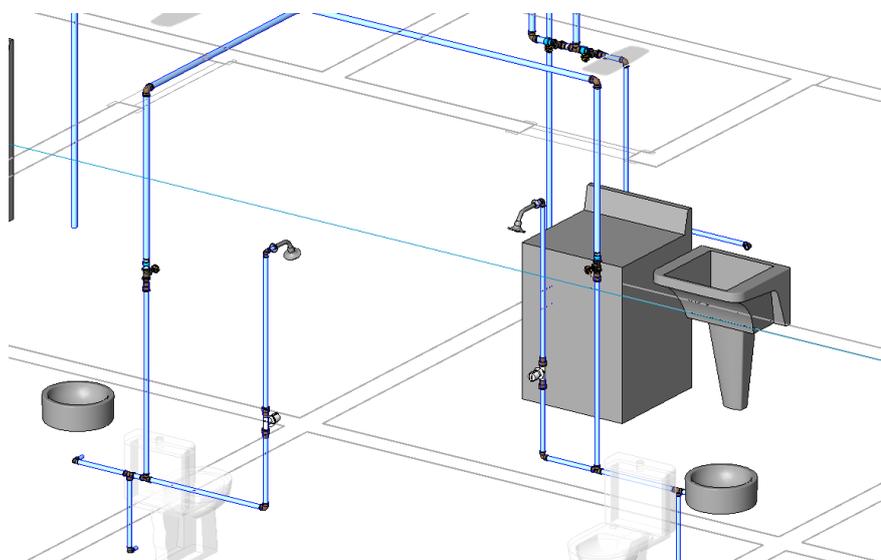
Traçado do sistema de água fria da lavanderia e banheiro do pavimento tipo através do AutoCAD na vista tridimensional
